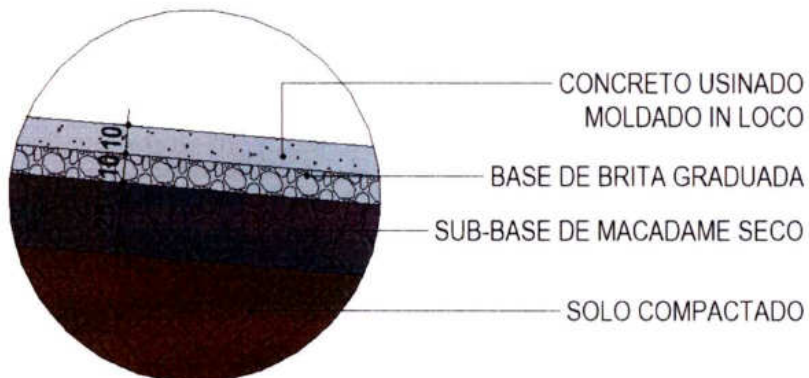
Corte Pavimentação Estrutura de Concreto (Rampas e Passeio)
